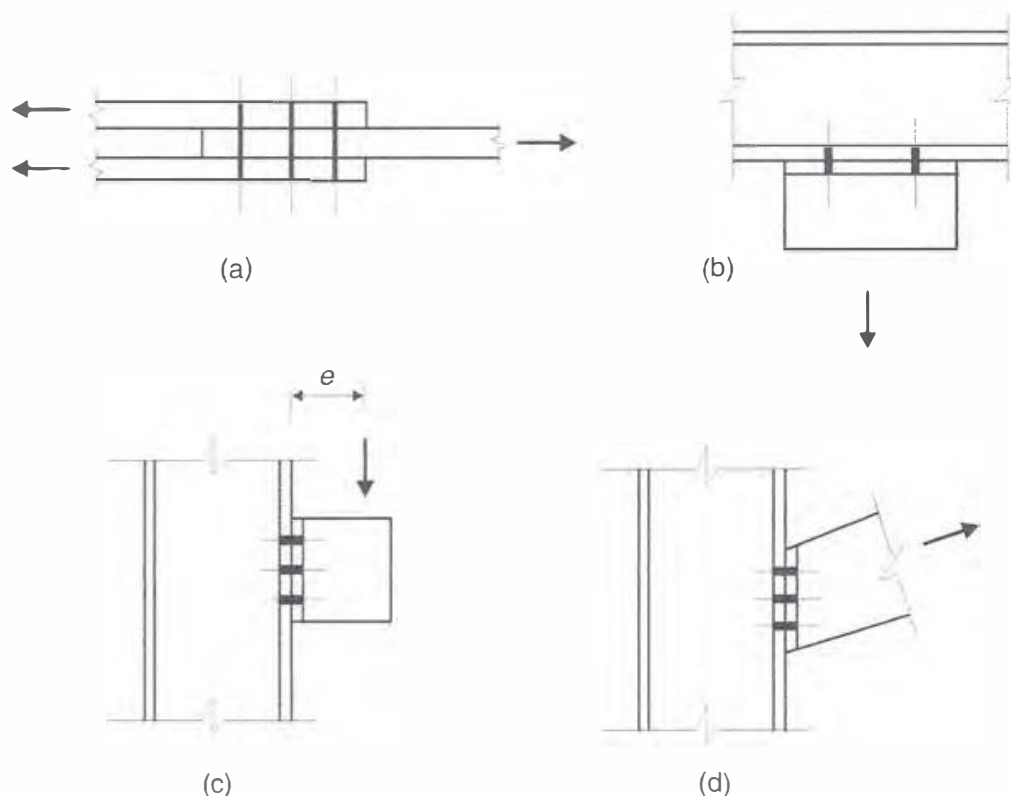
(a) Ligação por corte; (b) ligação por tração; (c) e (d) ligações a corte e tração dos conectores.
